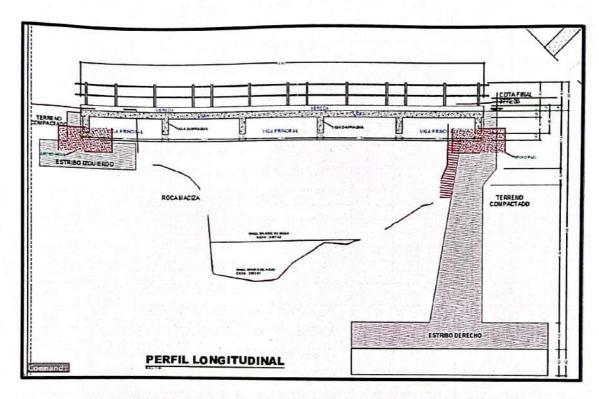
Imagen de Corte de Puente proyectado en la Ruta CU 1396
